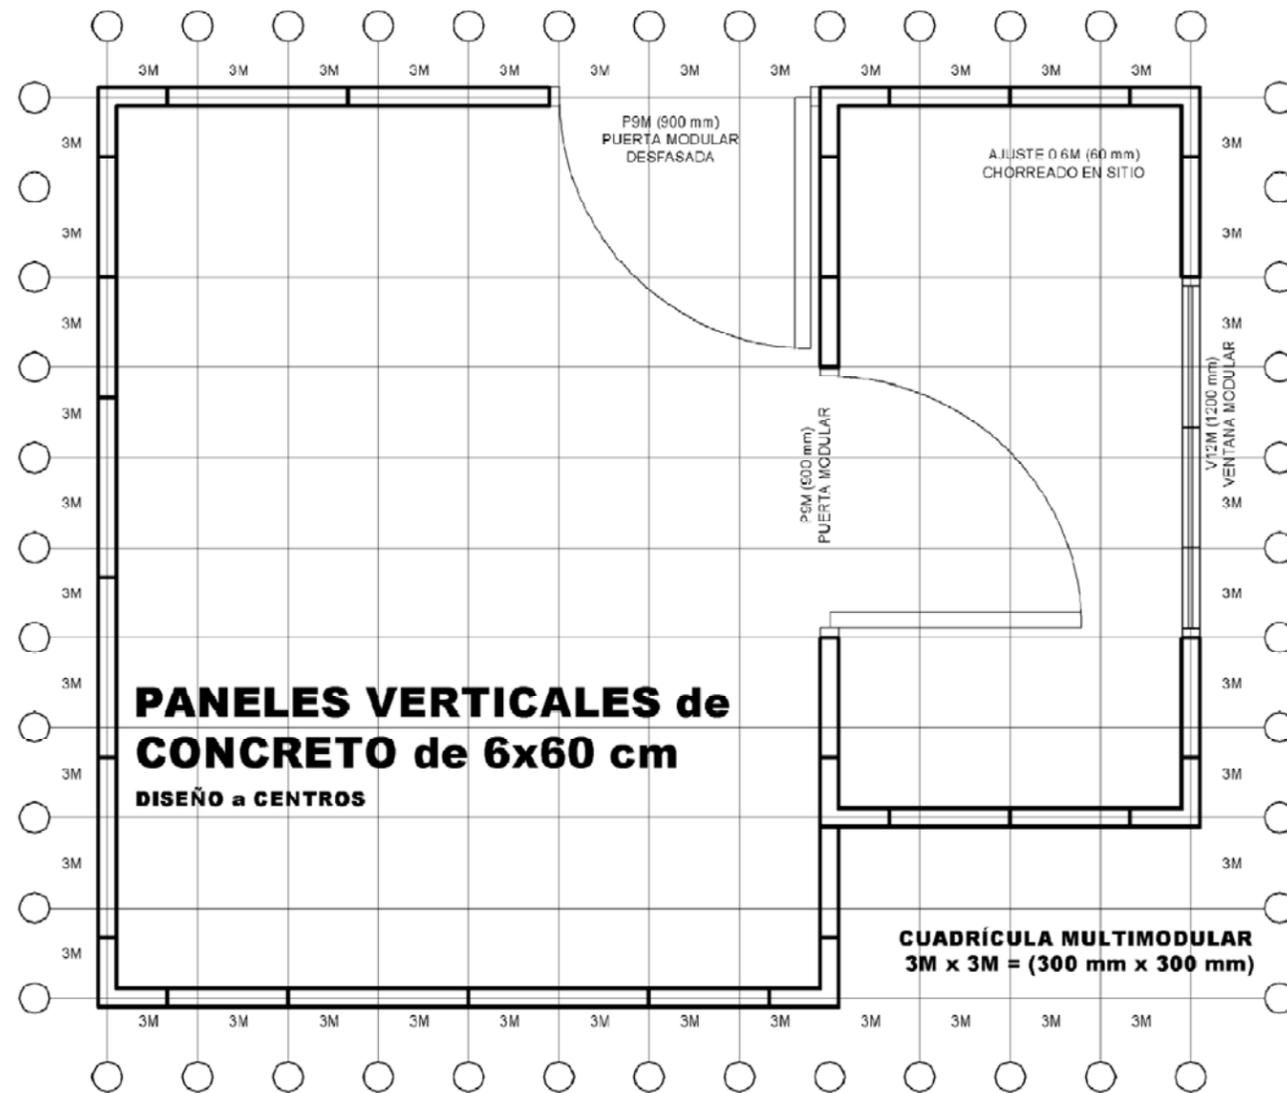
Paneles Verticales de Concreto (INTE 06-05-01-08, 2007)
